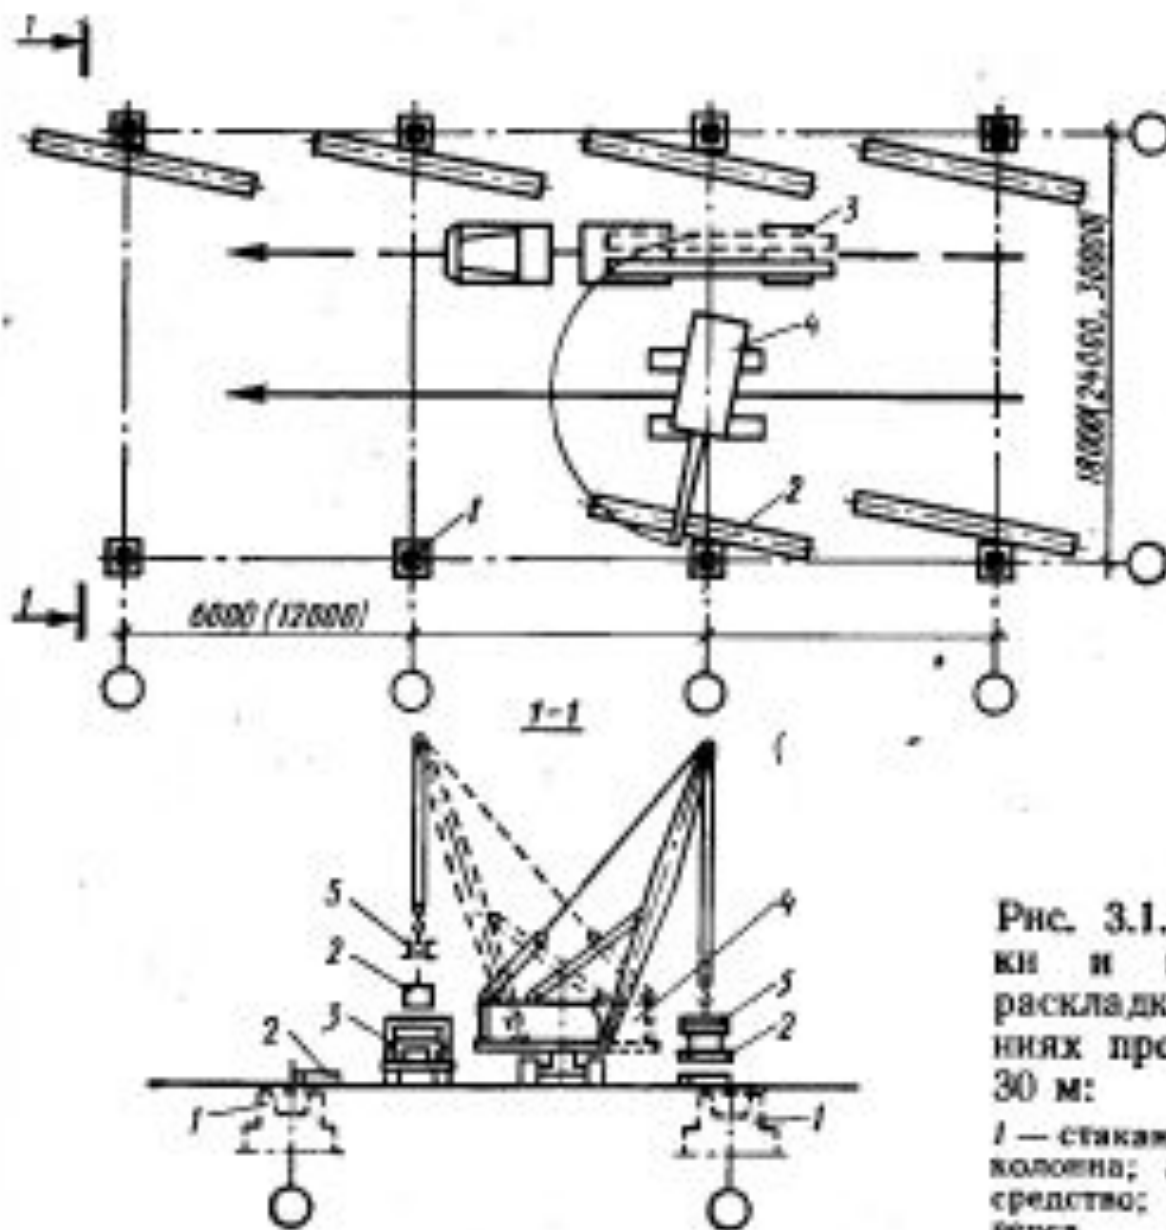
Схема выгрузки и предварительной раскладки колонн в зданиях пролетом 18, 24 и 30 м:
